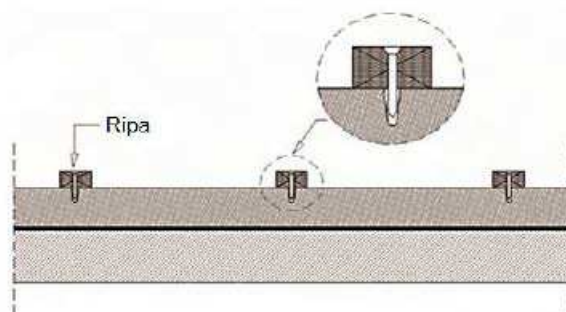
Sistema de fixação seco com pregagem de ripas ao suporte [33]
